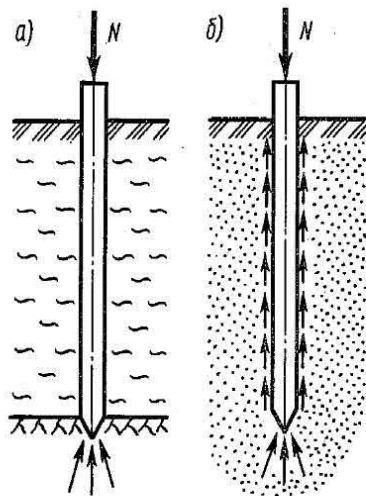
Схемы передачи нагрузки сваями на грунты основания
